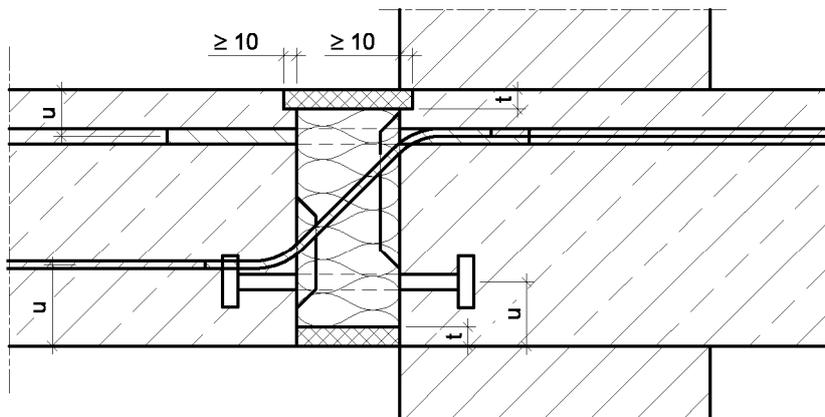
Schöck Isokorb Typ KX, Typ K und Typ KF (F30/F90)
